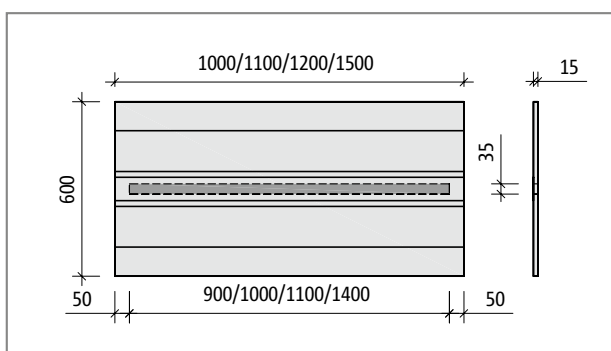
Schöck Tronsole® tipo B-V2-L...-B600, pianta del prodotto
